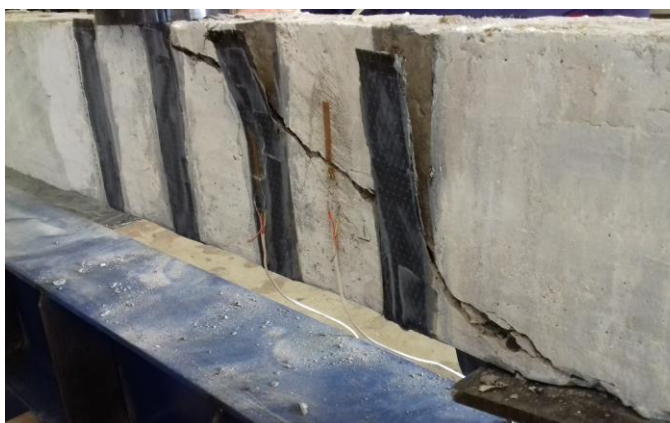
Panorama de fissuração – Viga VCR
